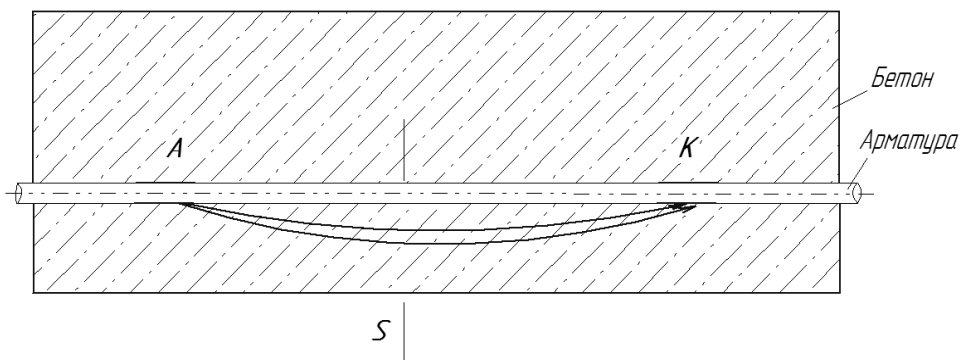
Схема роботи макрокорозійної пари на арматурі залізобетонної конструкції:
